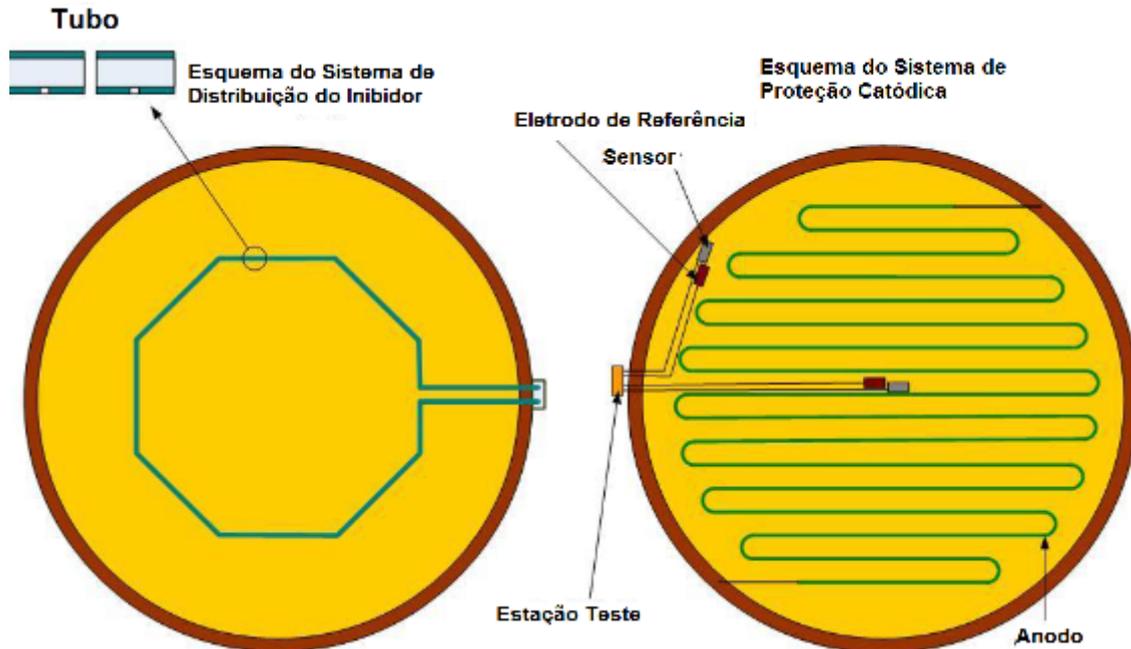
Sistema Combinado de Proteção Contra Corrosão da Superfície Interna do Tanque AST-DB.
